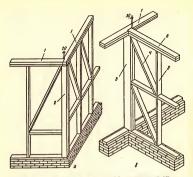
Элементы каркаса наружных (а) и внутренней (б) стен: 1 и 6— верхине обвазки наружных и внутренней стен; 2— угловая стойке; 3 и 5— стойки внутренней стены; 4— подкос
